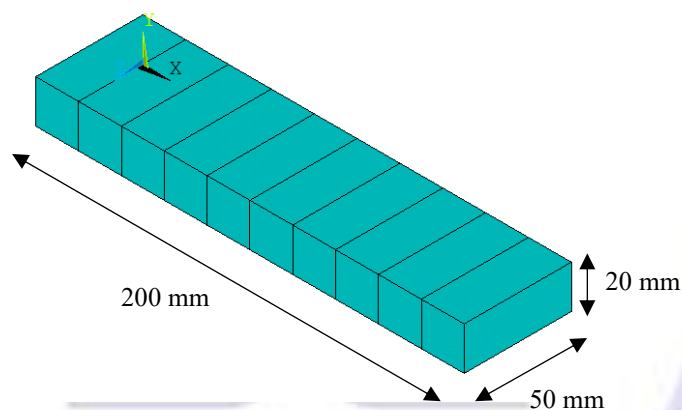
4 Penampang Element Kecil Balok Beton 20x20x50 mm
